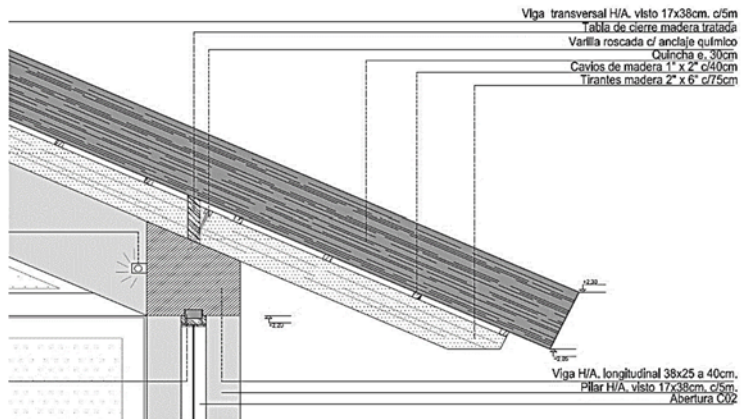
Portal del Polonio | Envolvente: detalle constructivo cubierta encuentro cerramiento vertical.
